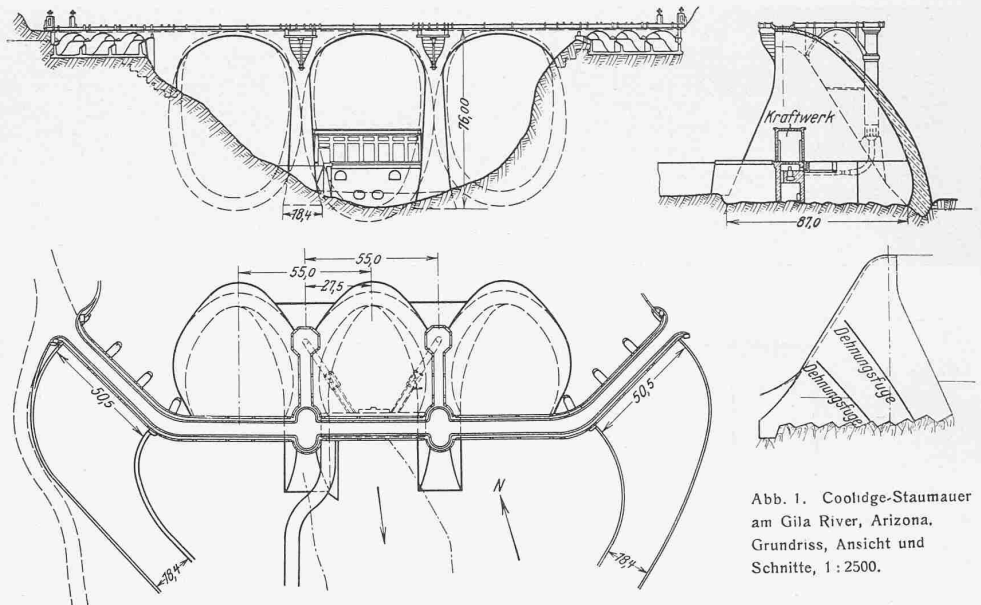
Coolidge-Staumauer am Gila River, Arizona. Grundriss, Ansicht und Schnitt, 1:2500.
